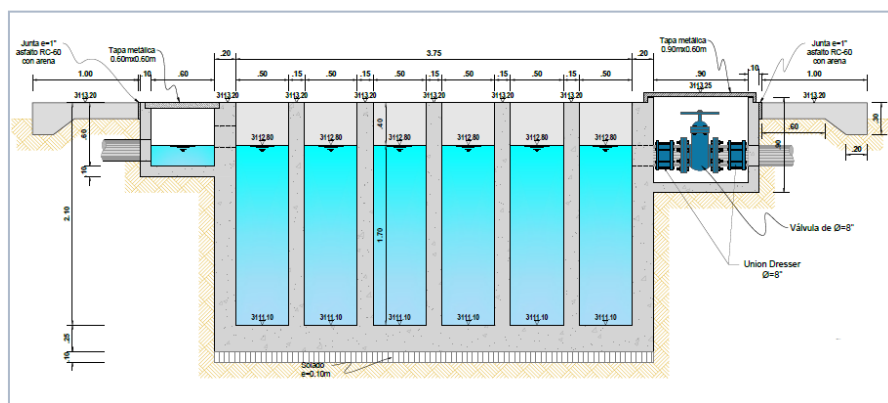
DETALLE DE CAMARA DE CONTACTO DE CLORO PLANTA
